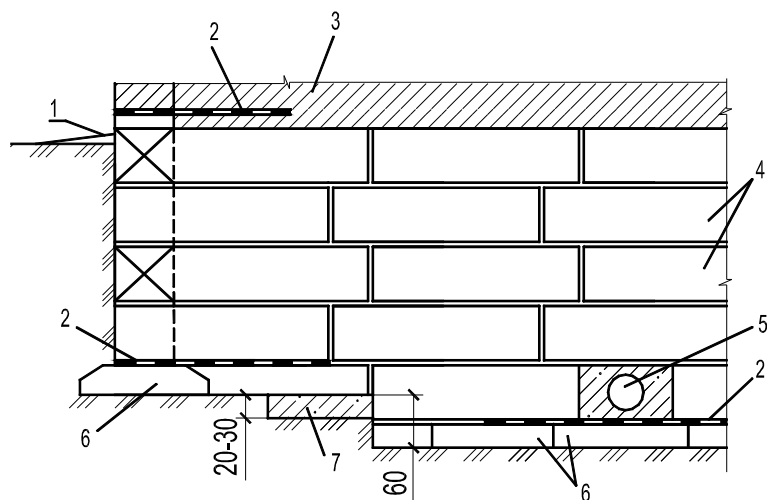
Примыкание поперечной стены к наружной (размеры в см):
